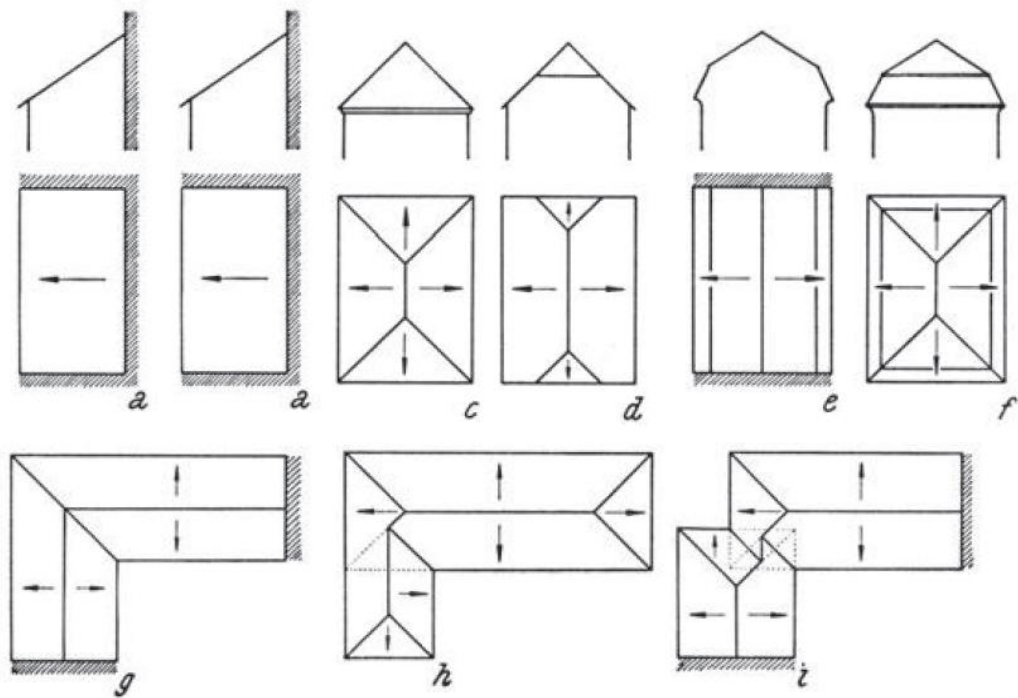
Dachformen. a) Pultdach, b) Satteldach, c) Walmdach (bei quadratischem Grundriß: Zeltdach), d) Krüppelwalmdach, e) Mansardendach, f) Mansardenwalmdach, g) Satteldach über Eckhaus, h) Walmdach über freistehendem Haus mit zwei Flügeln ungleicher Tiefe, i) Eckhaus mit einspringender Ecke
